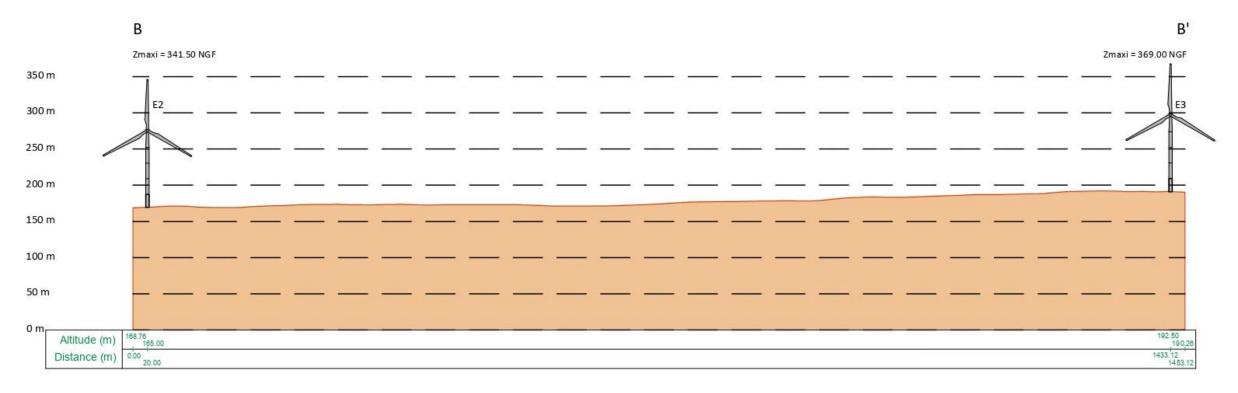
Plan de coupe des éoliennes E2 et E3
